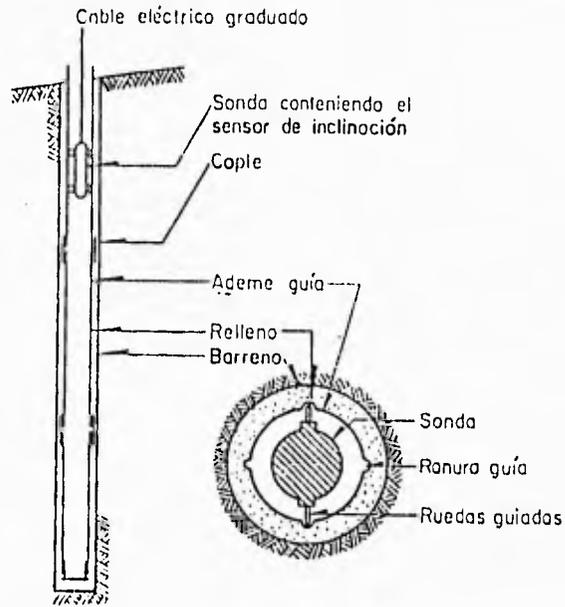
a Sonda dentro de la tubería del inclinómetro
